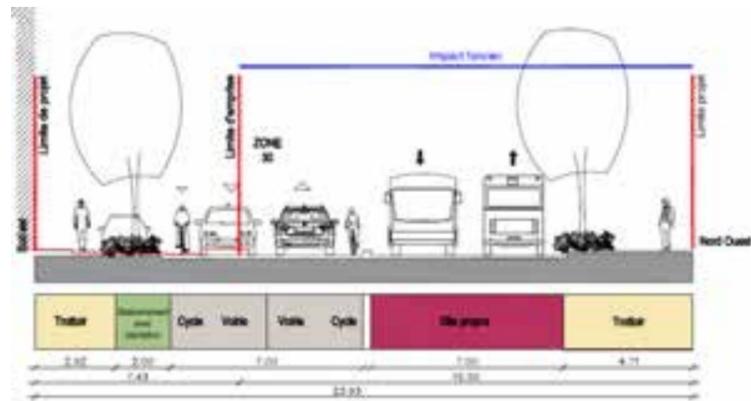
Coupe type en section courante avec site propre latéral sur la rue Michel Carré entre l'accès-sortie du O' Marché Frais et le boulevard du Général Delambre
